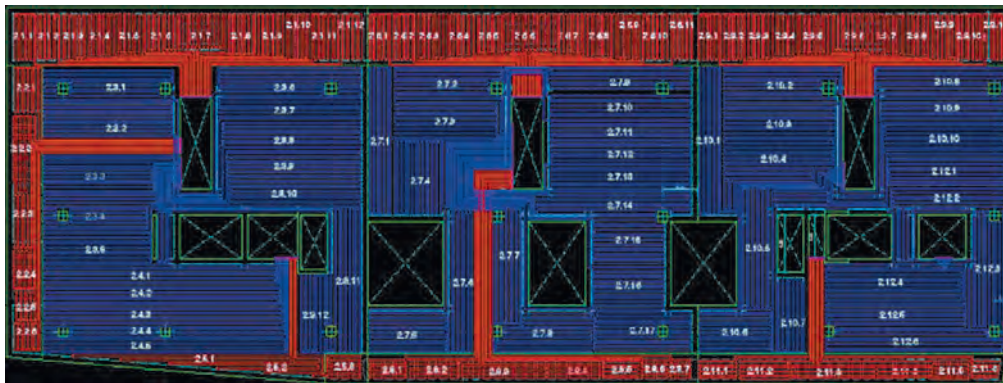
Plano constructivo de los circuitos de TABS de una planta completa de la sede de IDOM en Madrid.
